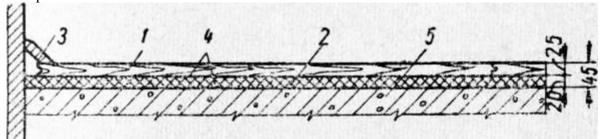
Конструкция пола из паркетных досок по сплошному звукоизоляционному слою 1— паркетная доска; 2—изоляционно-отделочные древесноволокнистые плиты объемным весом 250—350 кг\м\$\ 3—галтель; 4—холодная мастика; 5—железобетонное перекрытие
